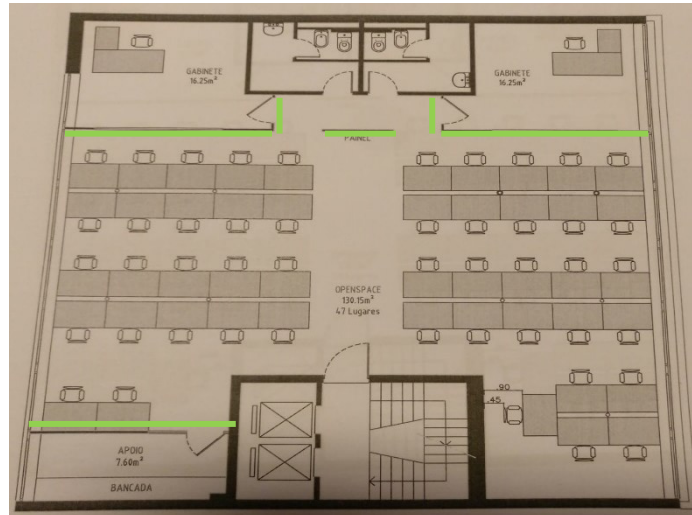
Planta do piso 1, onde passaria a existir copa de apoio.
